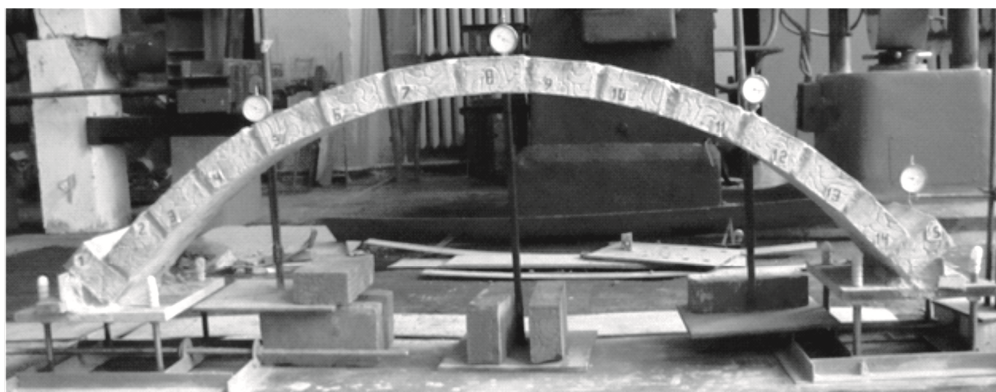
Установка для испытания каменной арки на вертикальную подвижку опоры
